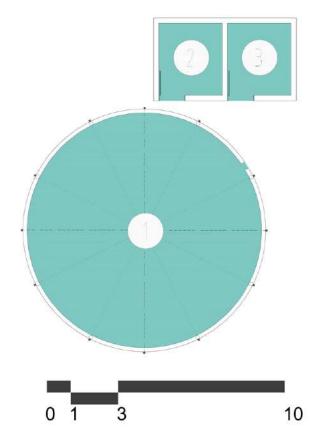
Planta 1 Bloque 53. Fuente: Equipo de diagnóstico.
